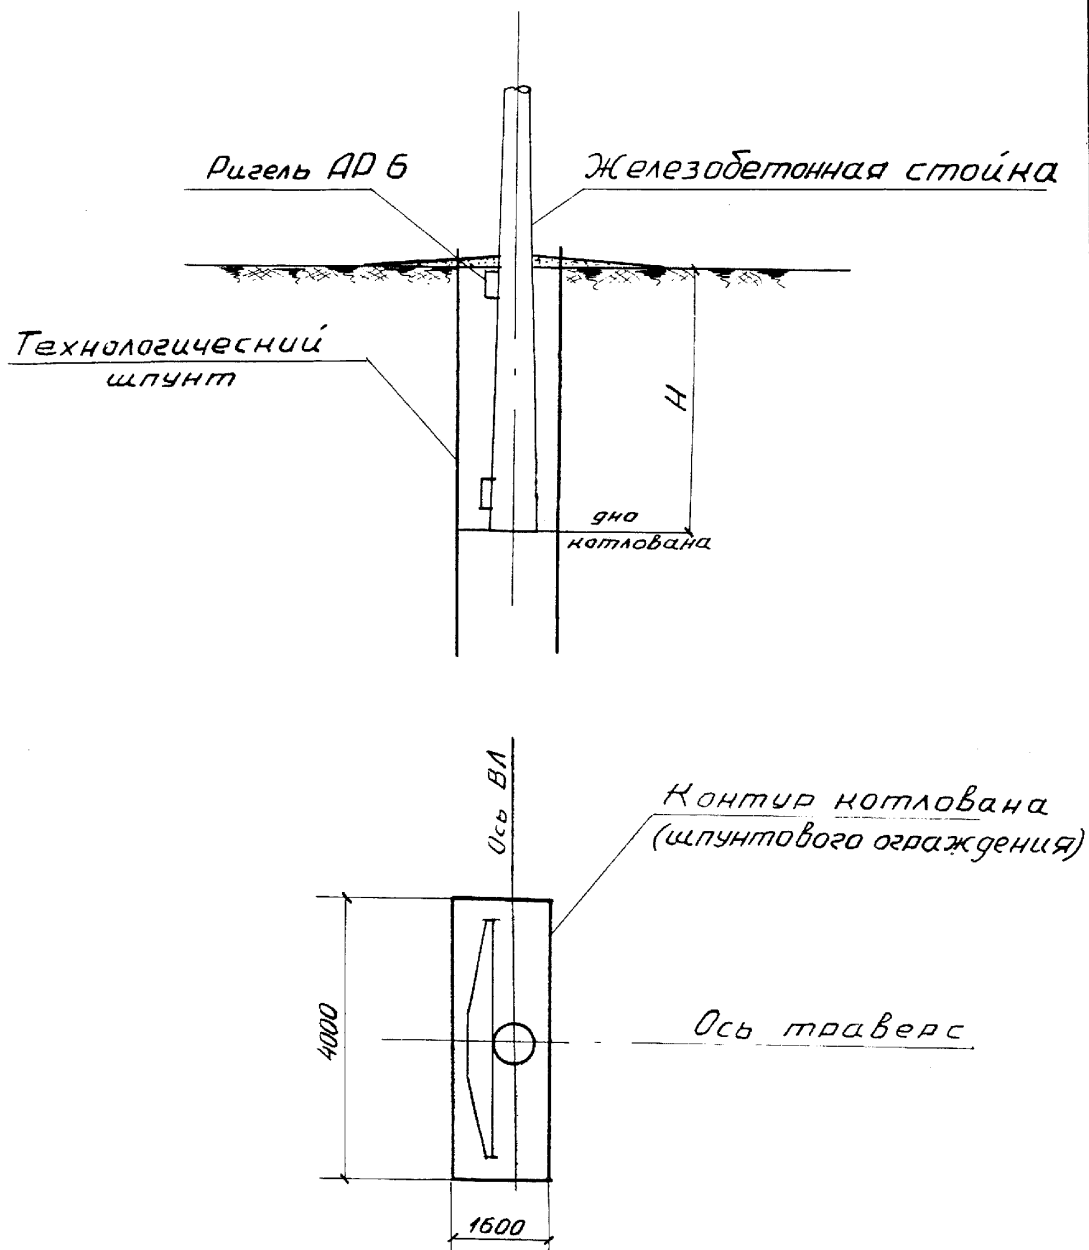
Закрепление железобетонной стойки в грунте. Тип II
